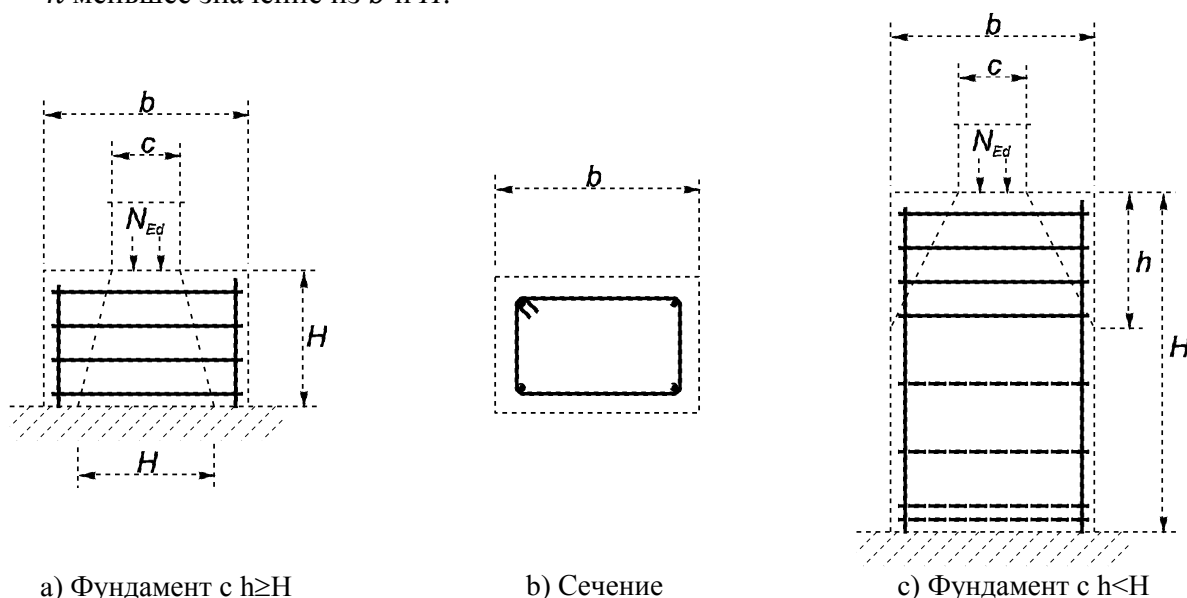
Арматура, воспринимающая сдвигающие усилия, для фундамента на скальных грунтах
